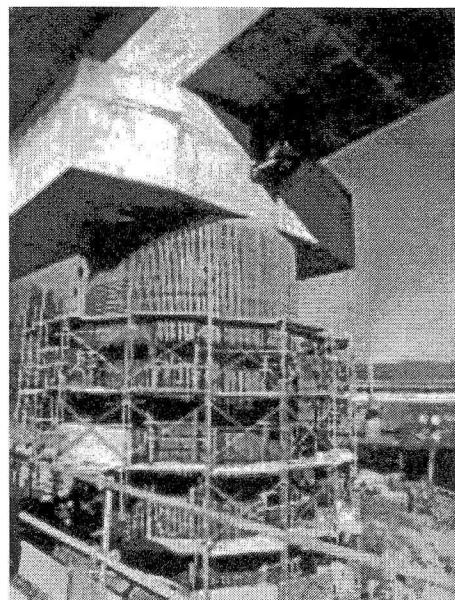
魚谷川橋梁の橋脚の補強（内陸部）
